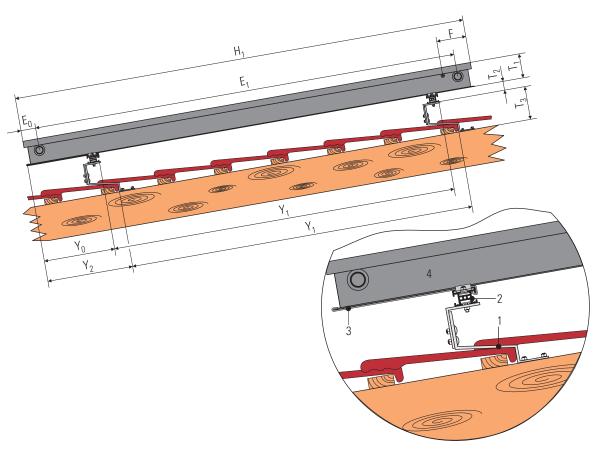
Vista laterale di un collettore Solaris montato su tetto
